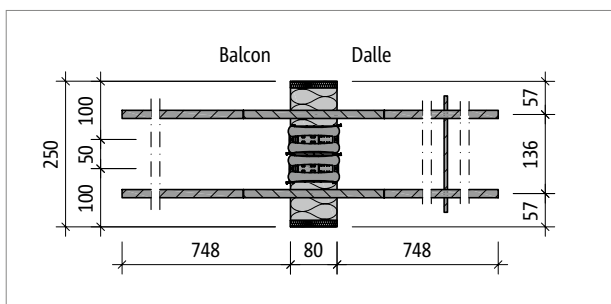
Schöck Isokorb® T type Q-E-V7-L250 : plan de base du produit
